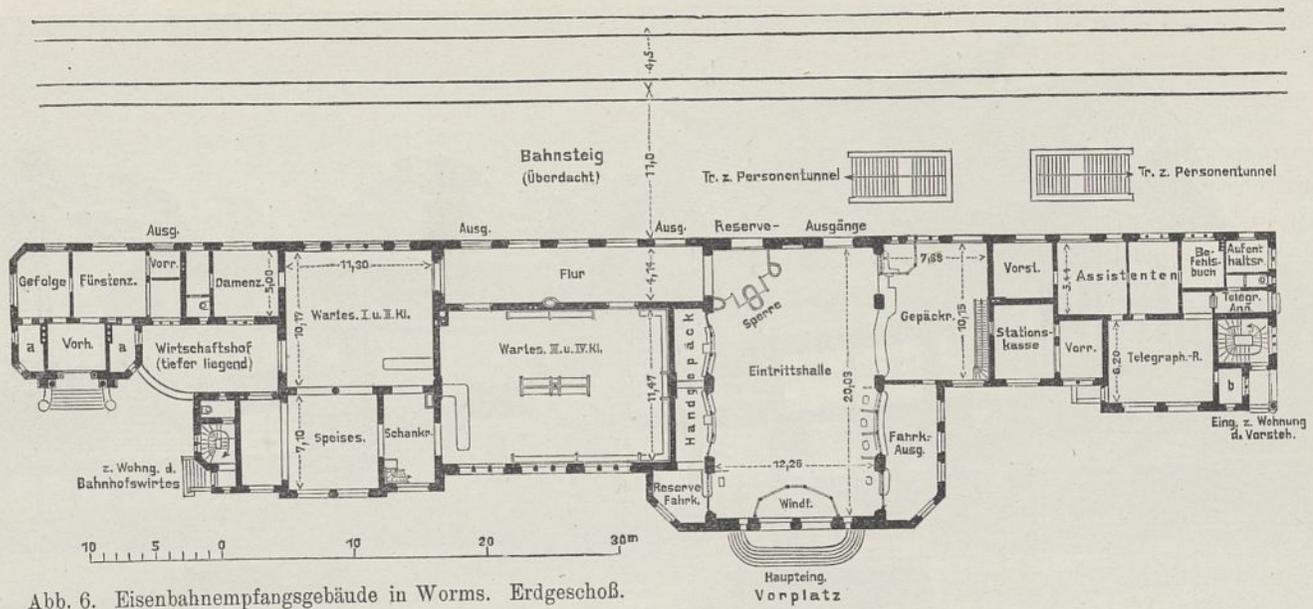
Eisenbahnempfangsgebäude in Worms. Erdgeschöß.
